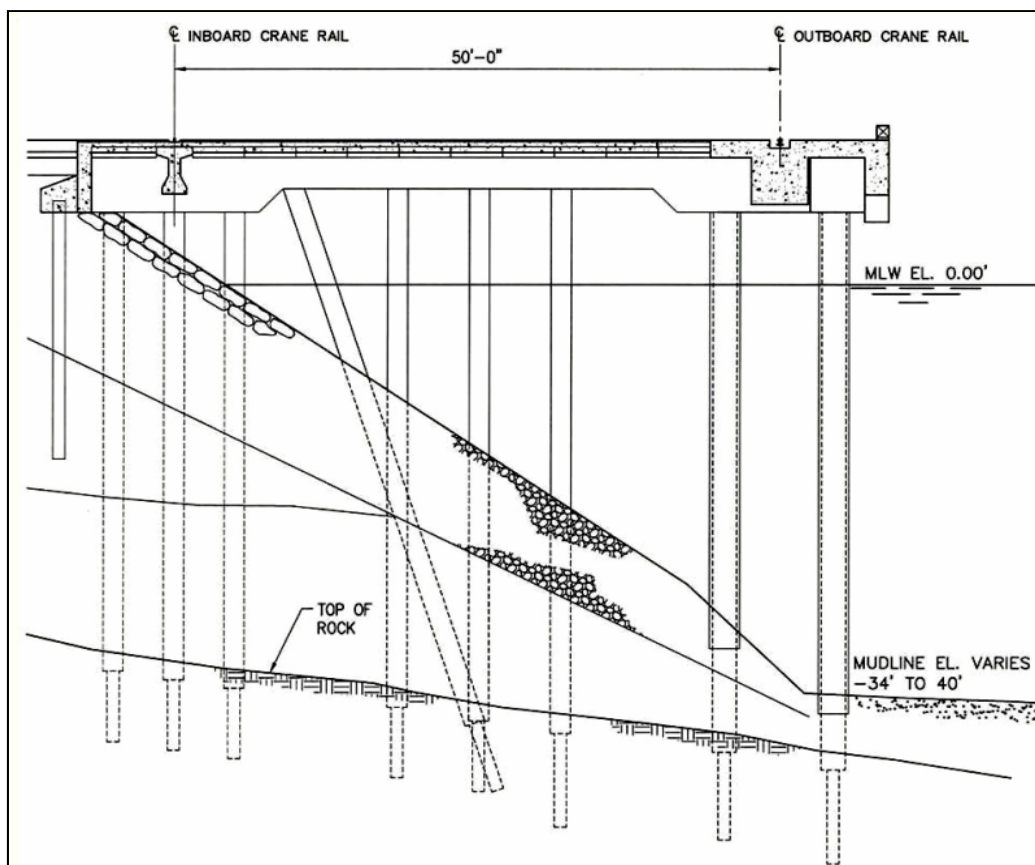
Perfil transversal anterior à intervenção (medidas em pés)
